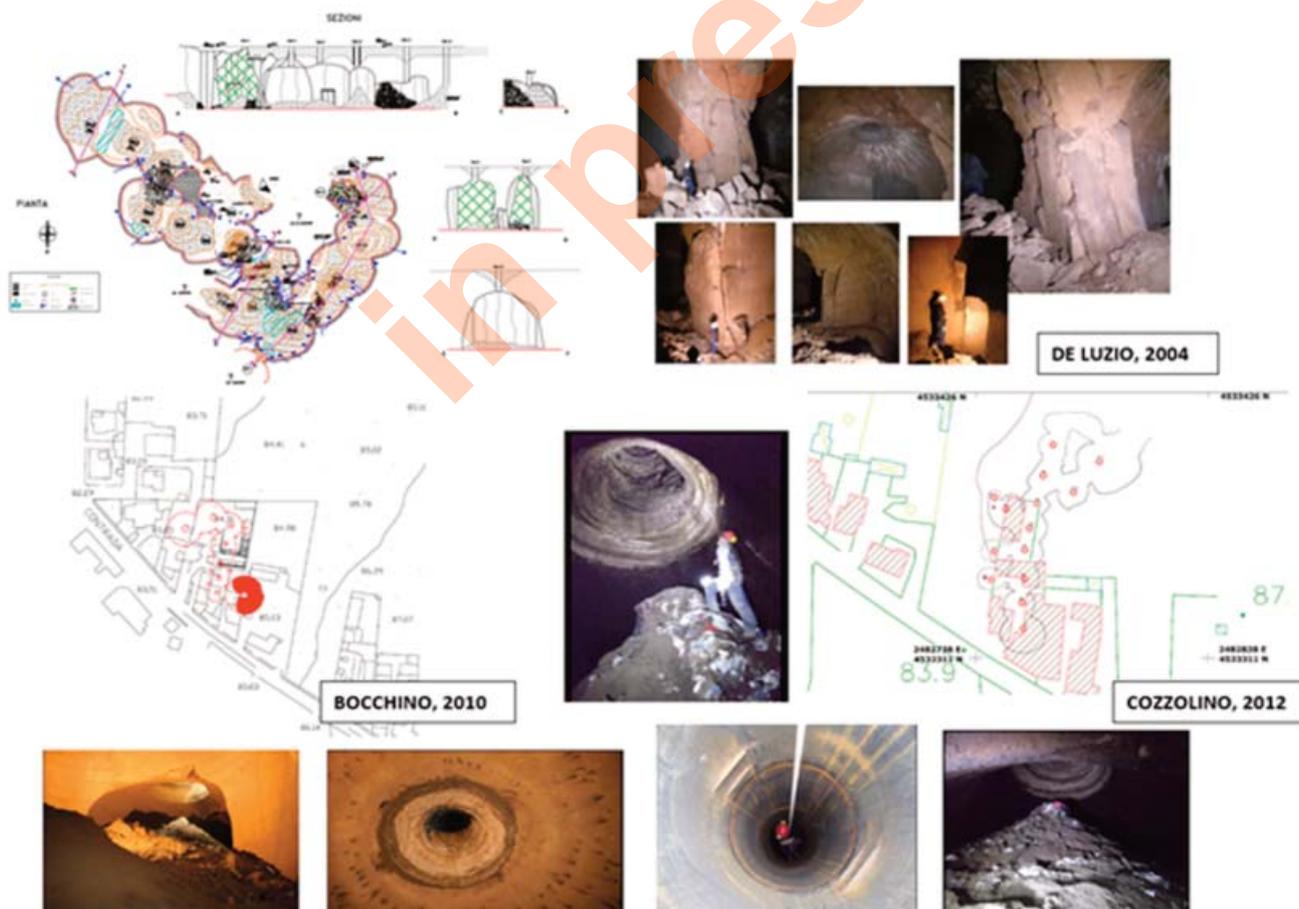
Rilievi planimetrici, topografici e strutturali delle cavità sotterranee.
